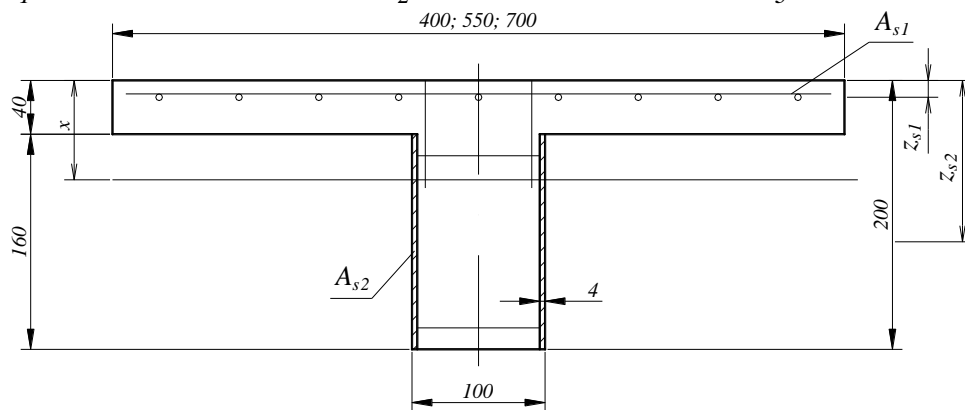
Розрахункова схема таврової сталезалізобетонної балки серій БТ-1-1, 2, 3
